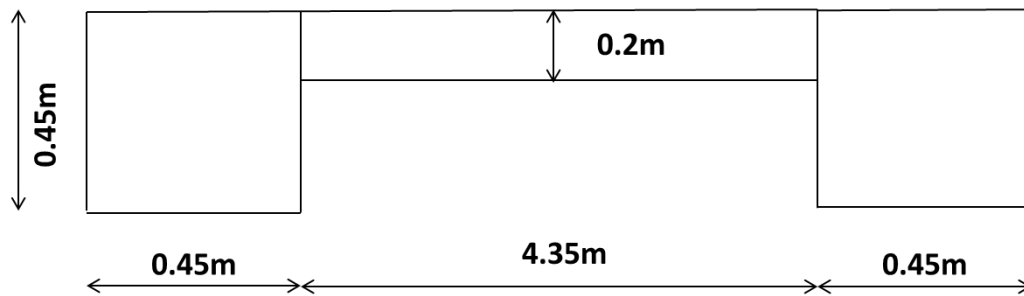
Schéma du voile type 1 et deux poteau.
